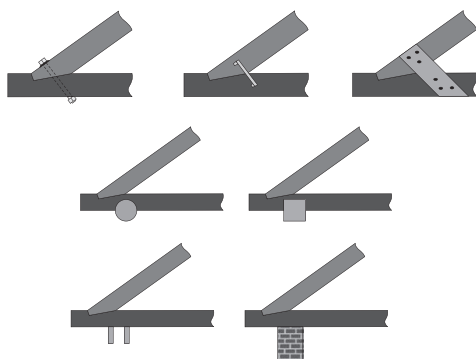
Способы крепления стропил к балке по типу конструкции стен
